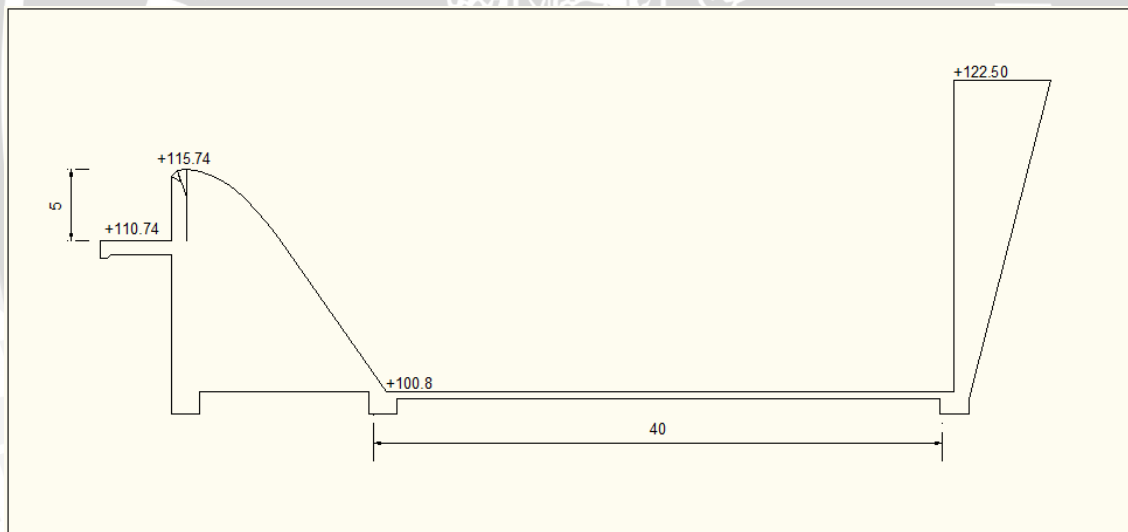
Perencanaan profil mercu pelimpah Bendungan Bintang Bano
